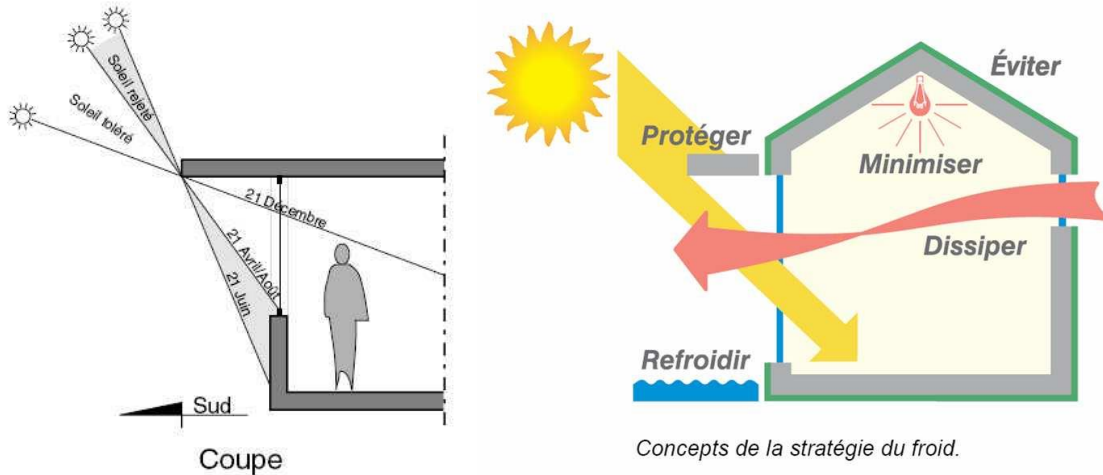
Protection fixe par une avancée de toit en façade sud.
